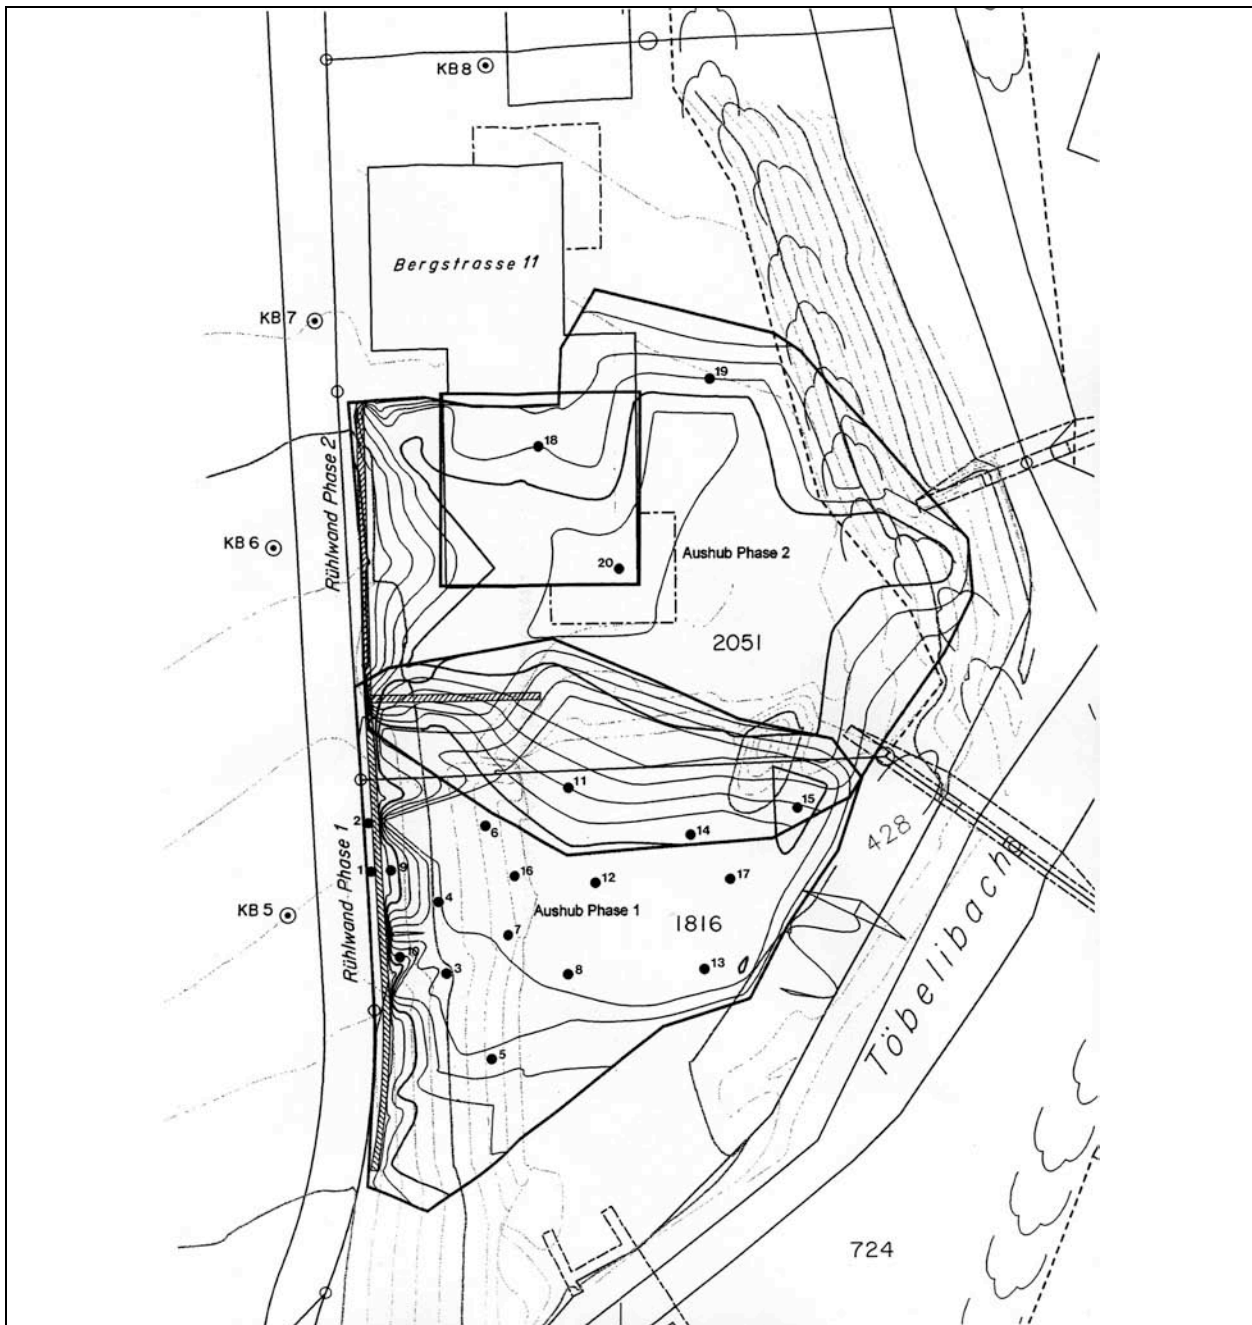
Situation betroffener Bereiche mit Angabe der Sondierschlitz und Bohrungen für Probeaufnahmen sowie Rühlwand
